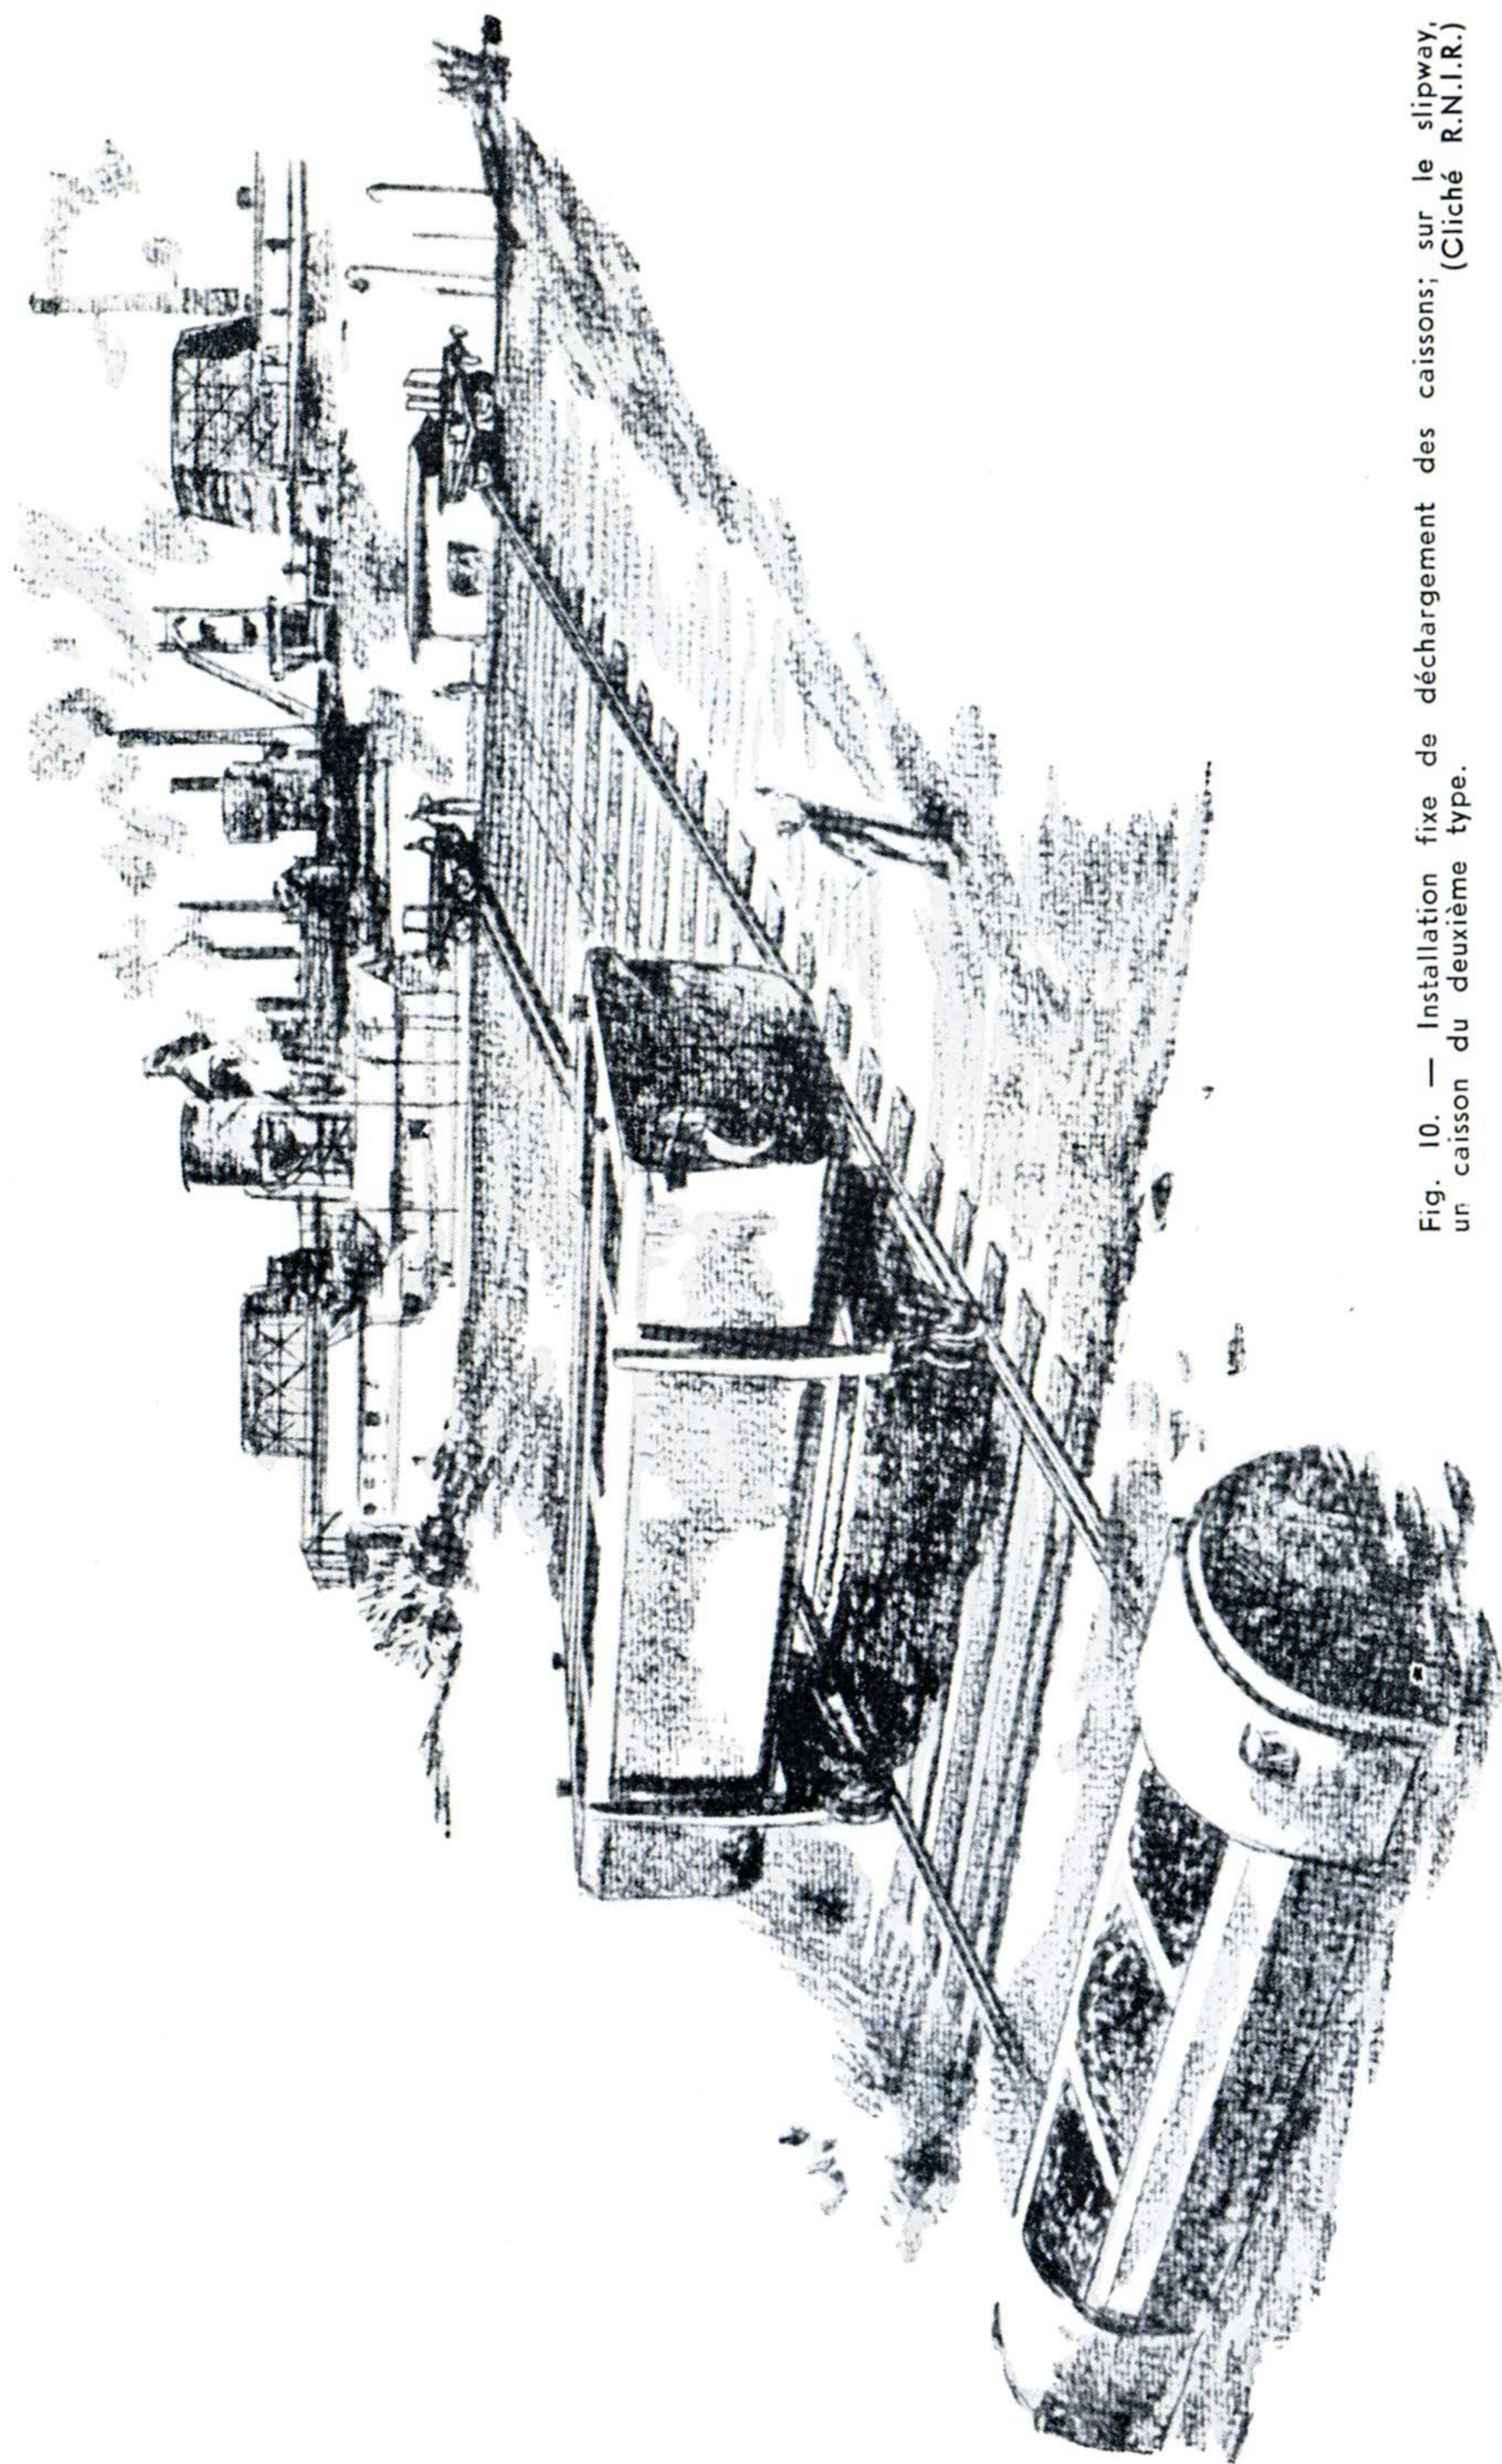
Installation fixe de déchargement des caissons; sur le slipway,
